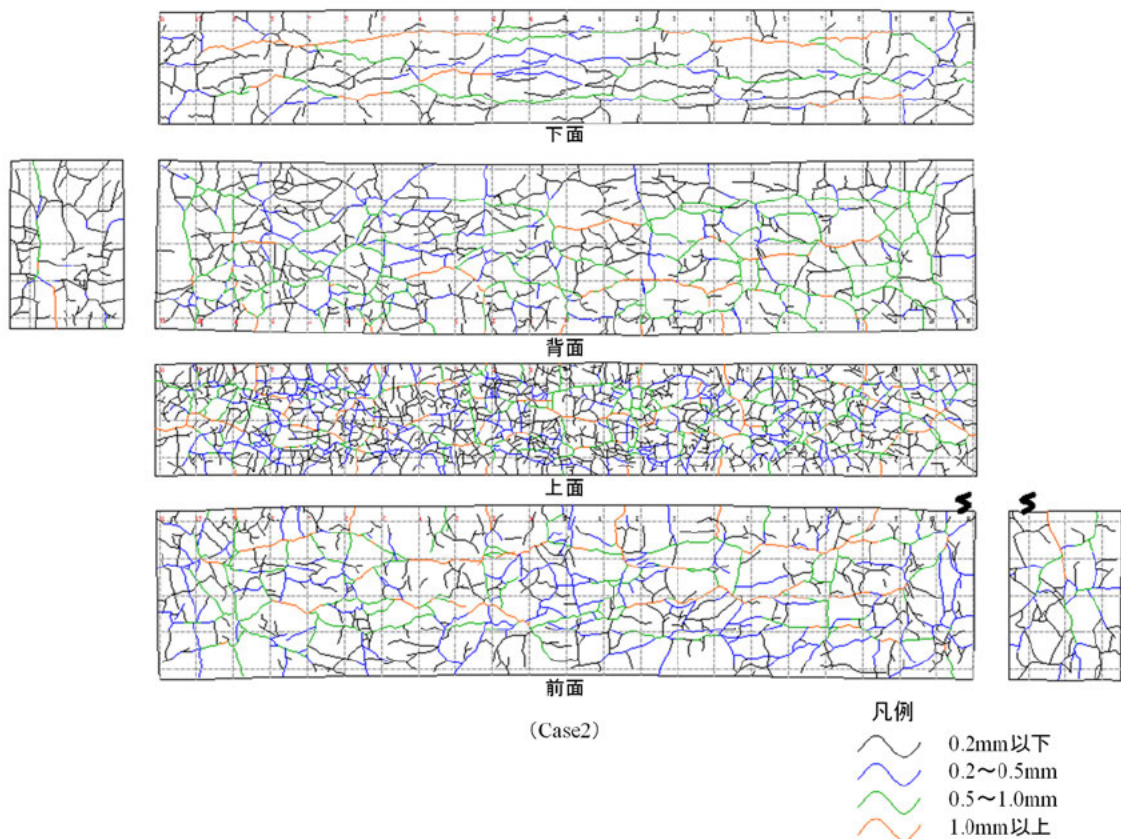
水中暴露後8年半経過時点の供試体ひび割れ状況
